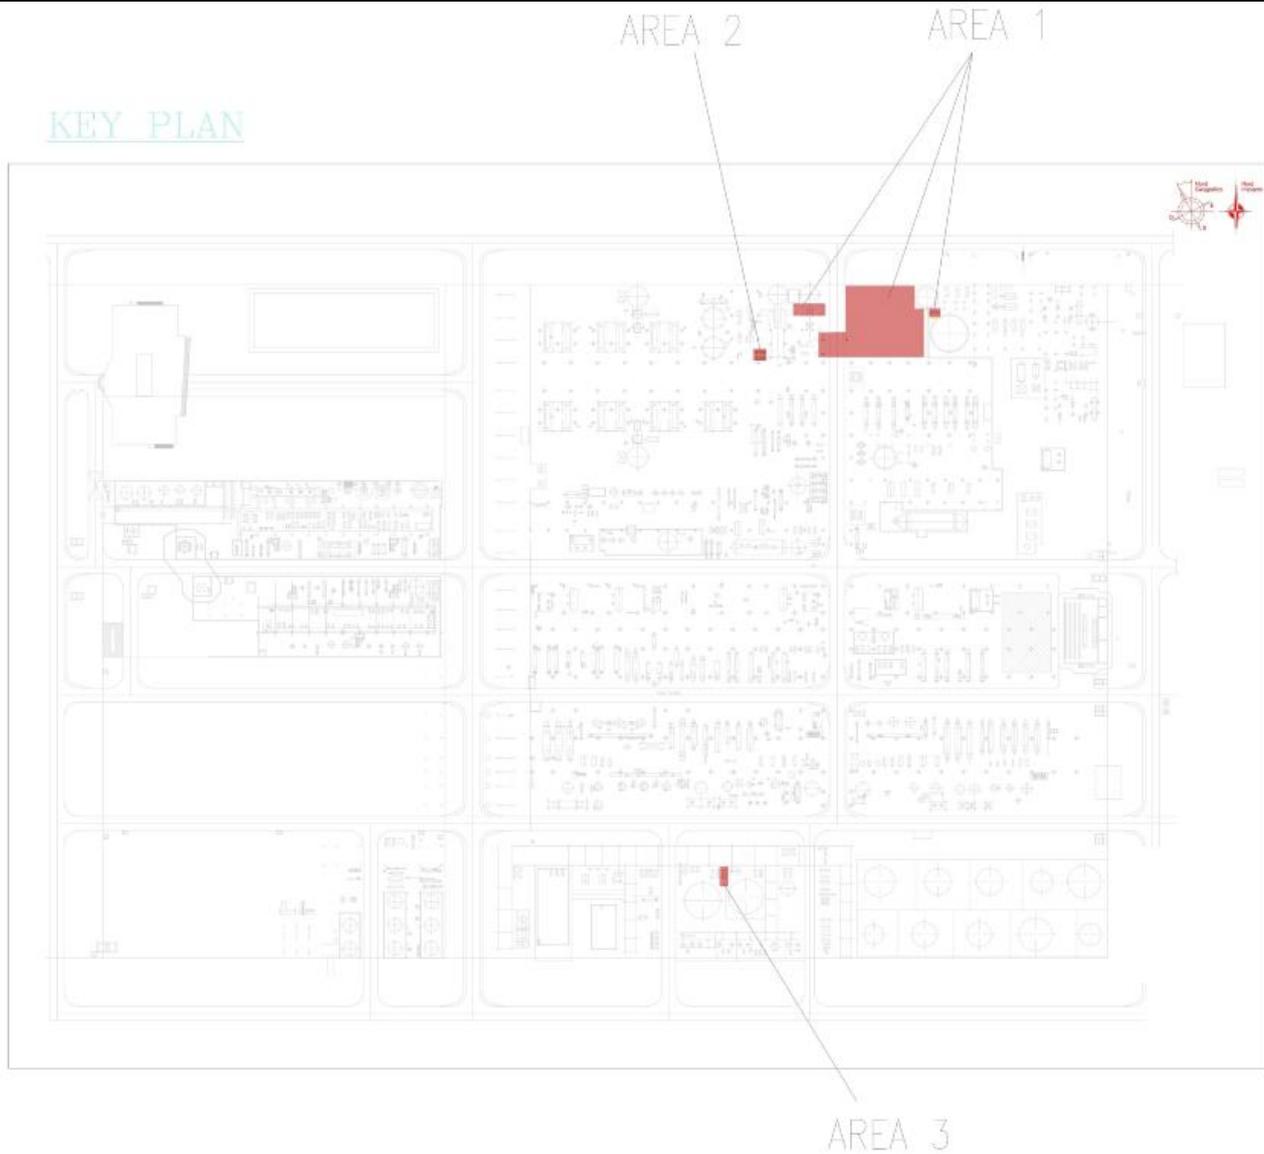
Dettaglio area di intervento all'interno dell'impianto Cracking
